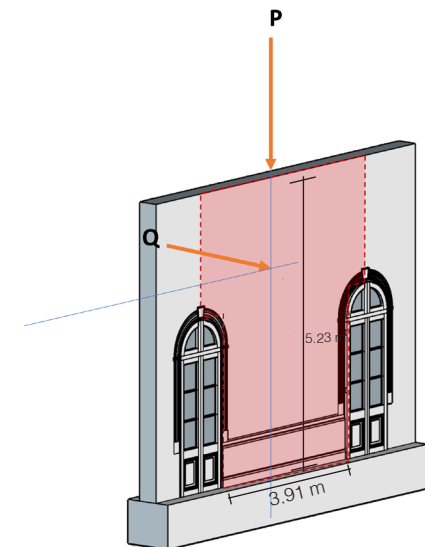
Aplicación de Carga Fuera del Eje del Muro
